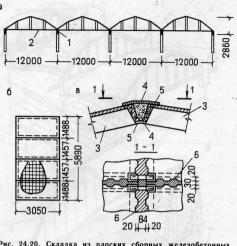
Складка из плоских сборных железобетонных элементов
